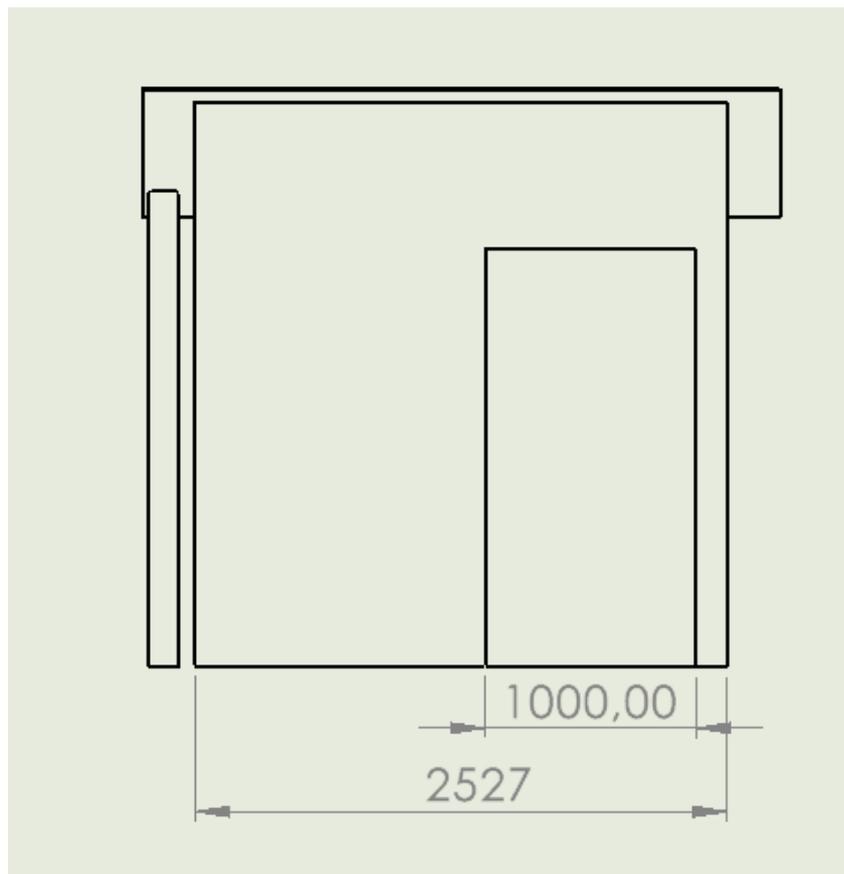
Alzado de la estructura del aseo unifamiliar. Fuente: Propia
